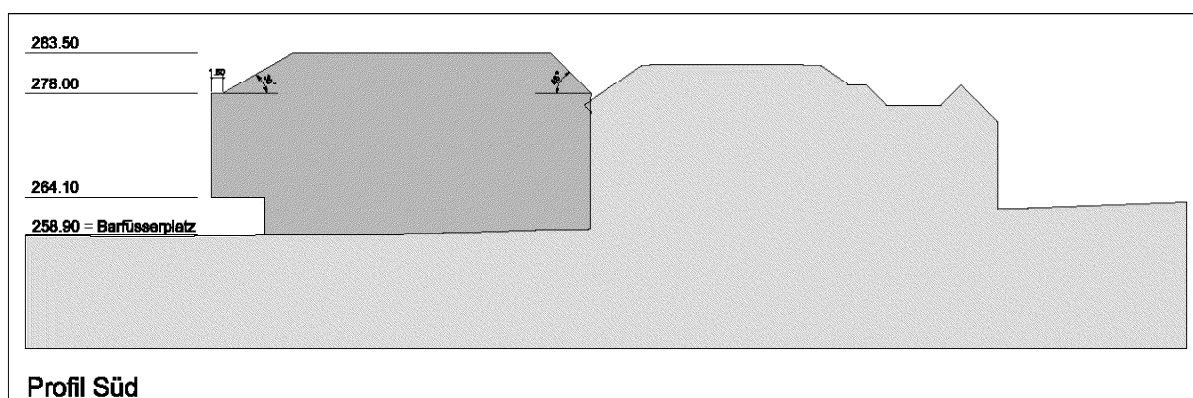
Plan Nr. 13'175. Bebauungsplan: Profil Süd. (kein Massstab)
